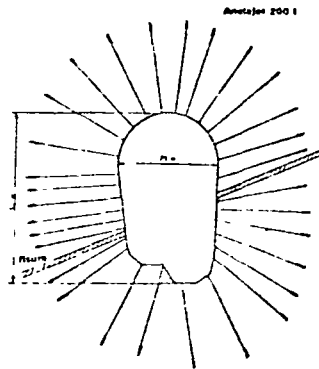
Sostenimiento de la central subterránea de Waldeck (Alemania Federal) en el macizo esquistoso. Cobertura 280 metros. Revestimiento hormigón proyectado con ferralla reforzada por anclajes de 200 t y bulonaje corto de 10 a 20 tn, (1 bulon) 12m²
